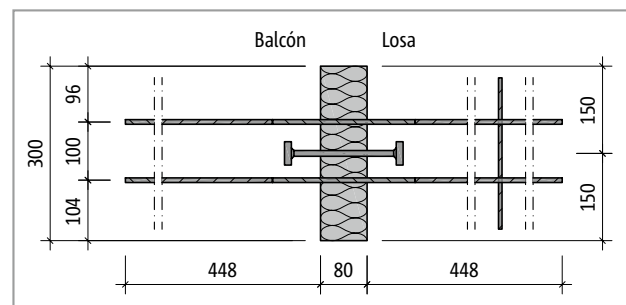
Schöck Isokorb® T tipo Q-P-V1 en R0: Plano del producto
